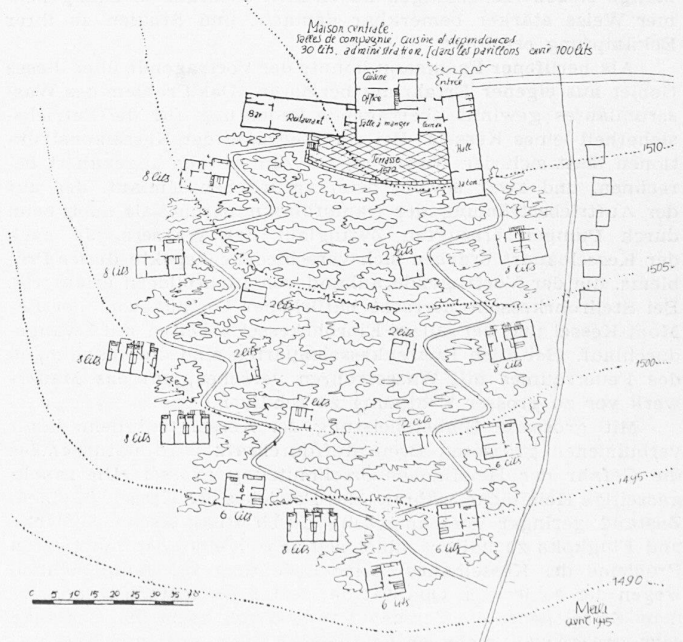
Grundriss zu Bild 6a, Masstab 1:1700
